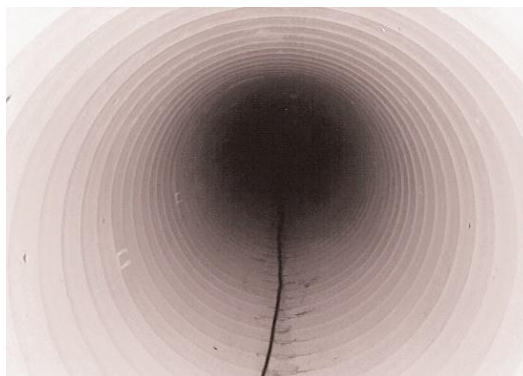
Aspeto Final do Revestimento em Espiral [33]
